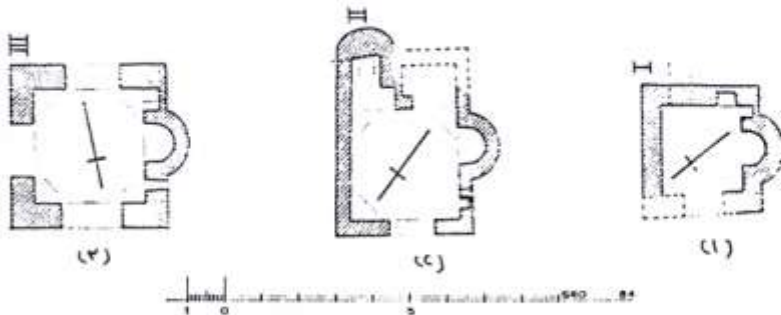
مسقط أفقي لكنيسة ٣ بتل محرض - وادي فيران نقلاً عن
